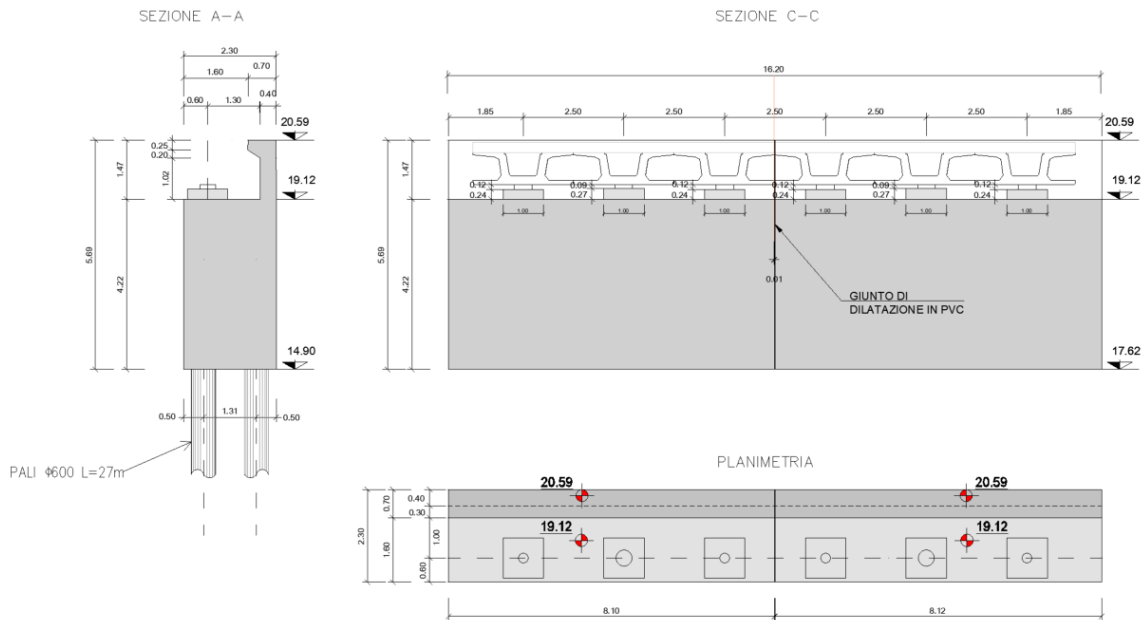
Sezioni e planimetria della spalla del ponte
